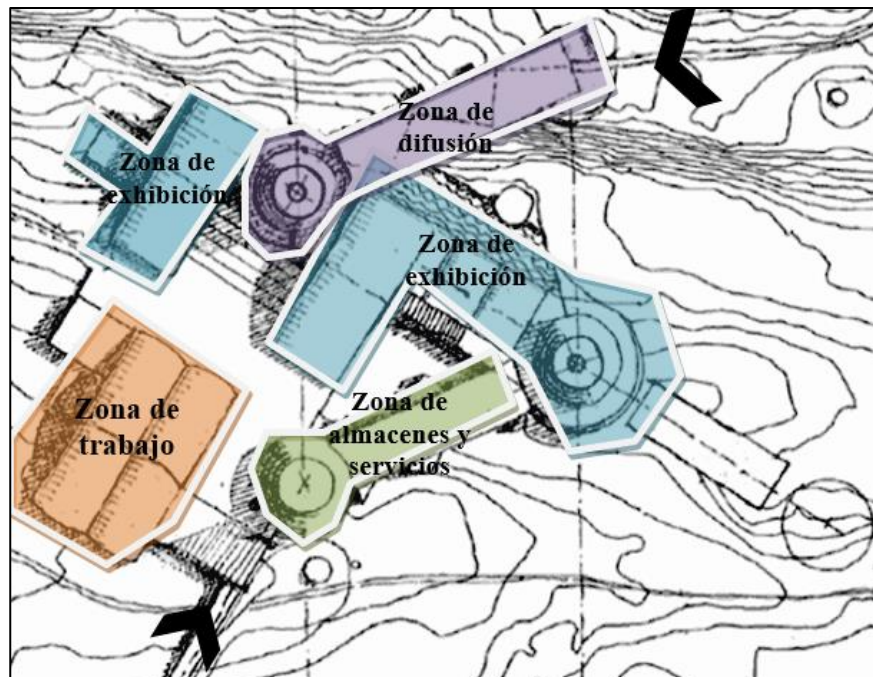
Plano de techos del conjunto donde se aprecia la zonificación general
